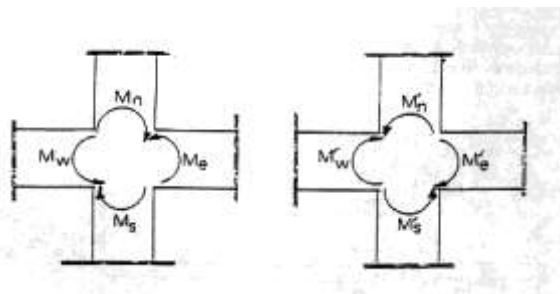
Spécifications pour les nœuds poteaux-poutres
